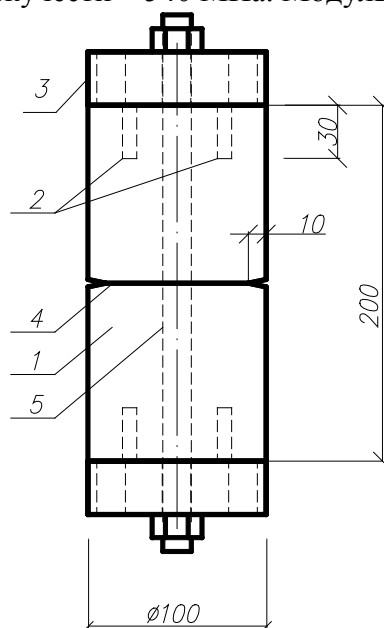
Конструктивное решение опытных образцов, образец, твердеющий в условиях одноосного сжатия: 1 – бетонный образец; 2 – анкера; 3 – захваты приспособления; 4 – кольцевой концентратор; 5 – металлический стержень.
